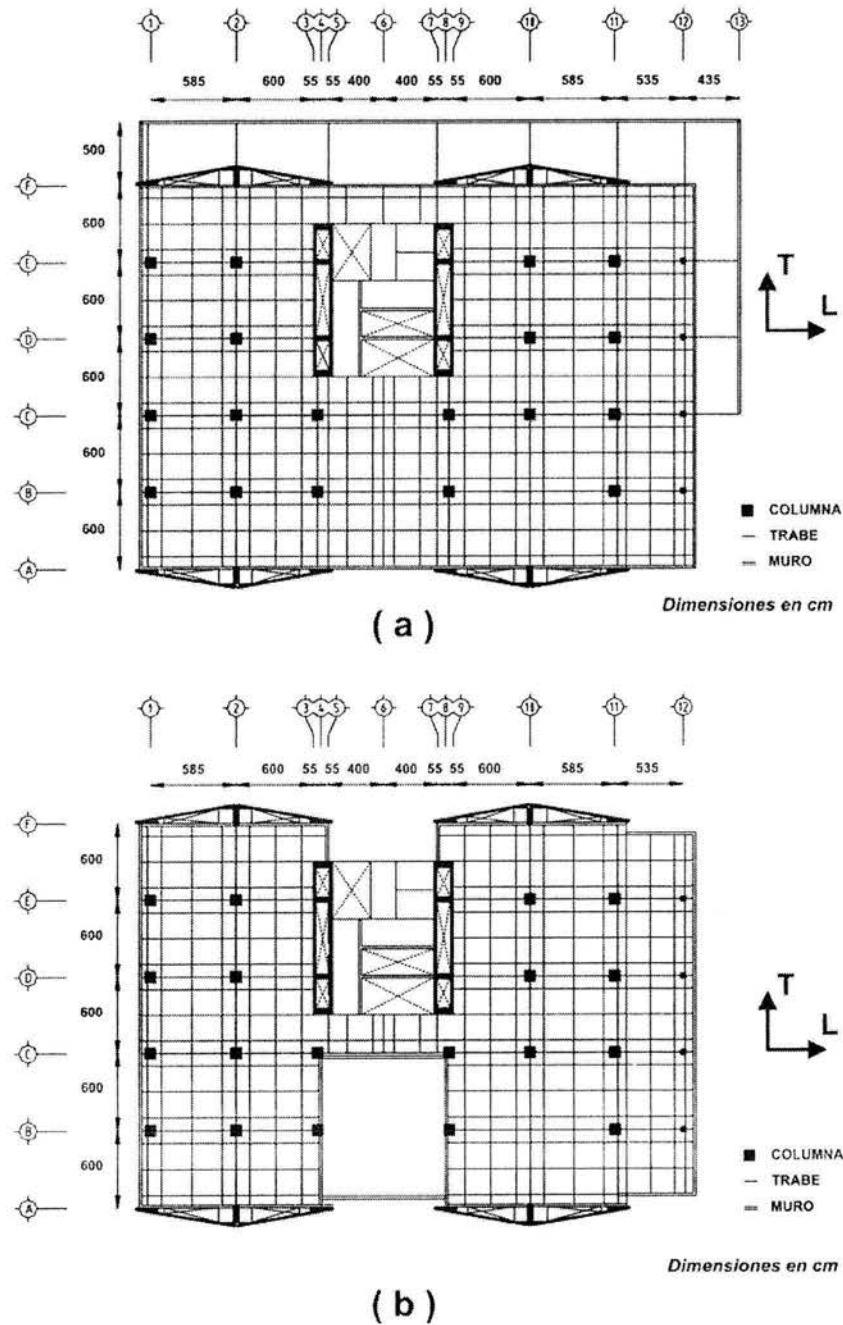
Plantas del edificio: (a) Planta Baja y (b) Planta tipo de los niveles 1 a 3
